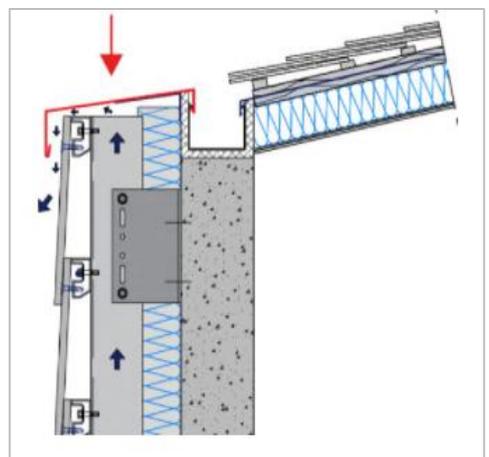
Tôle métallique d'acrotère d'une façade ventilée
